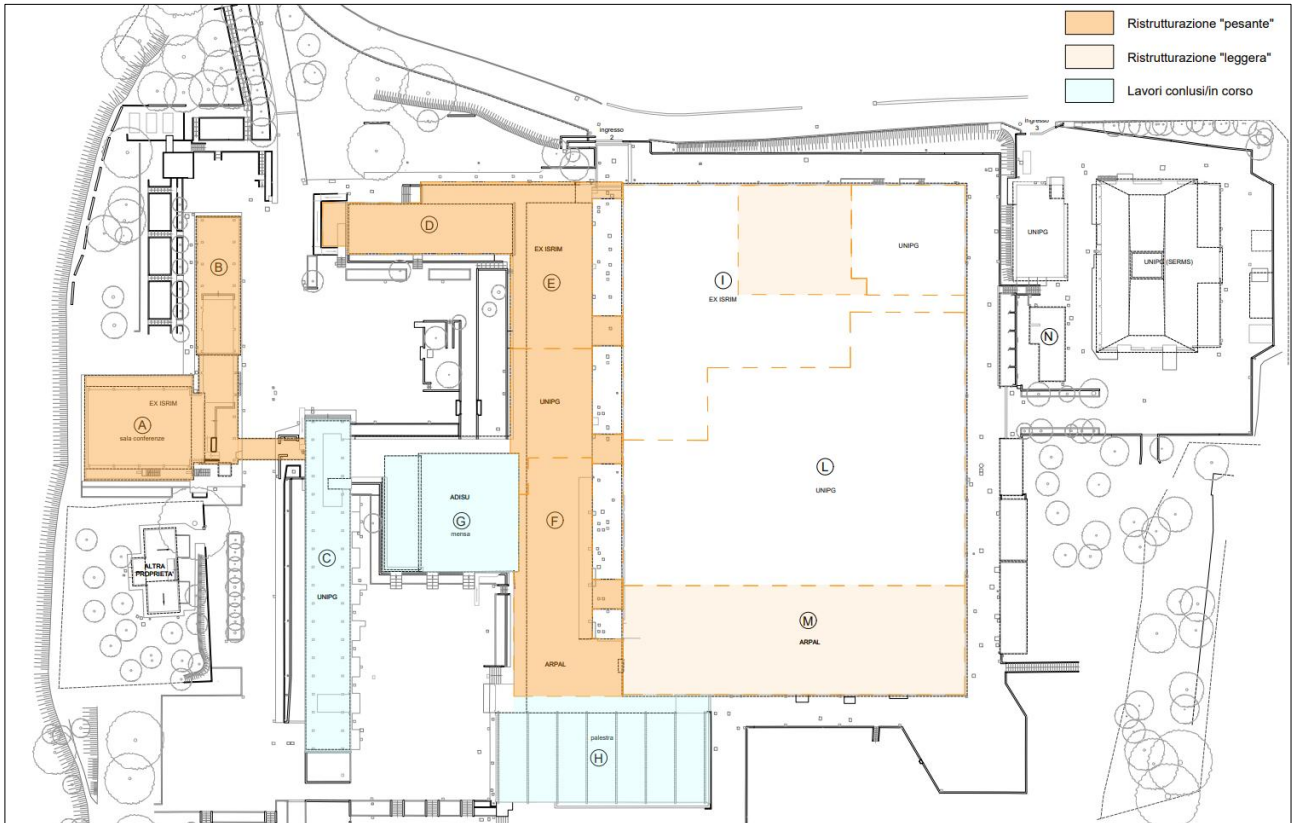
Planimetria generale con la distinzione dei fabbricati oggetto di interventi previsti nell'alternativa progettuale n. 2.
